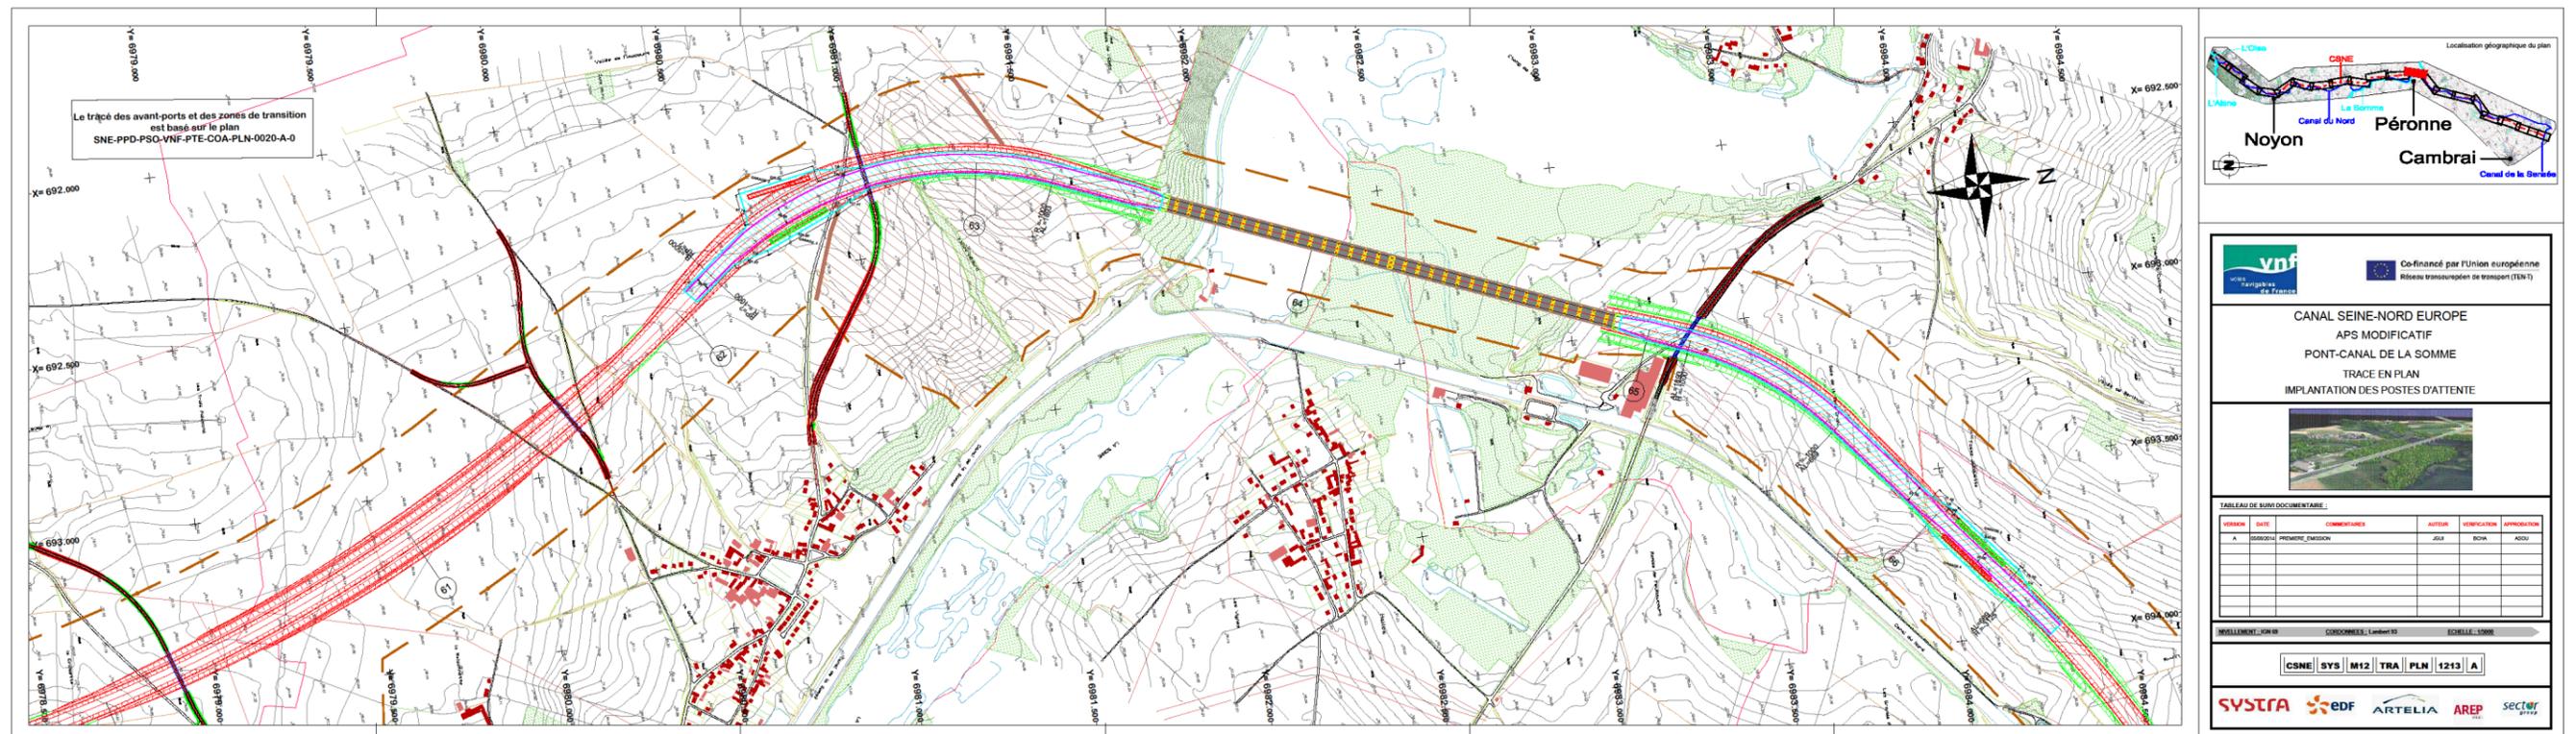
Vue en plan du pont canal de la Somme (source : SYSTRA, APSM)
